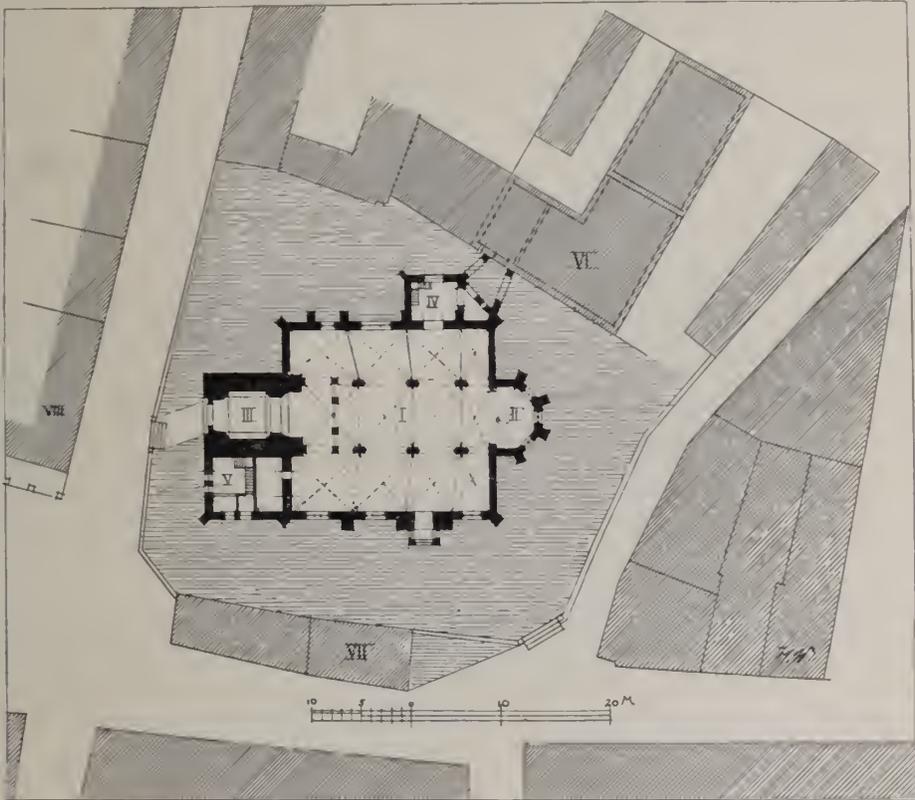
Hüls. Grundriss der Pfarrkirche.
